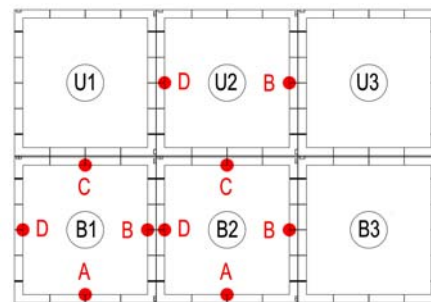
平面図とひずみ計設置位置 下段(B1, B2, B3)
